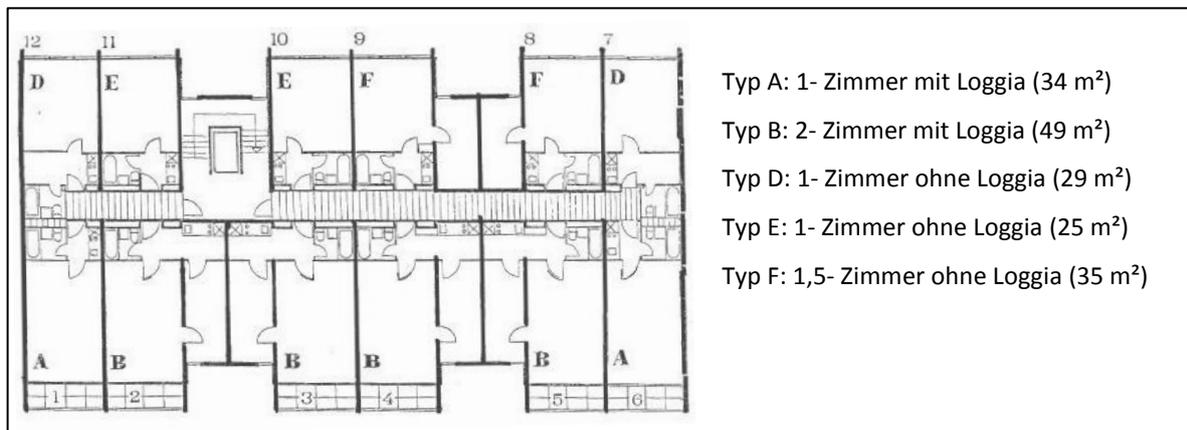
Grundrisse und Lage der Appartements der Feriersiedlung (Hausverwaltung Göllnitz, 2015)
